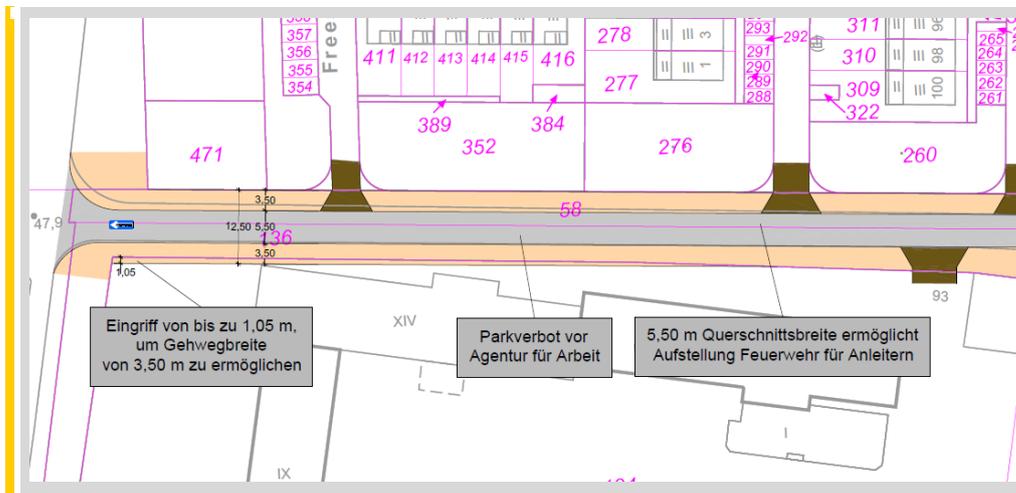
Ausschnitt 1, Lageplan Gotlindestraße (Anhang 7)
